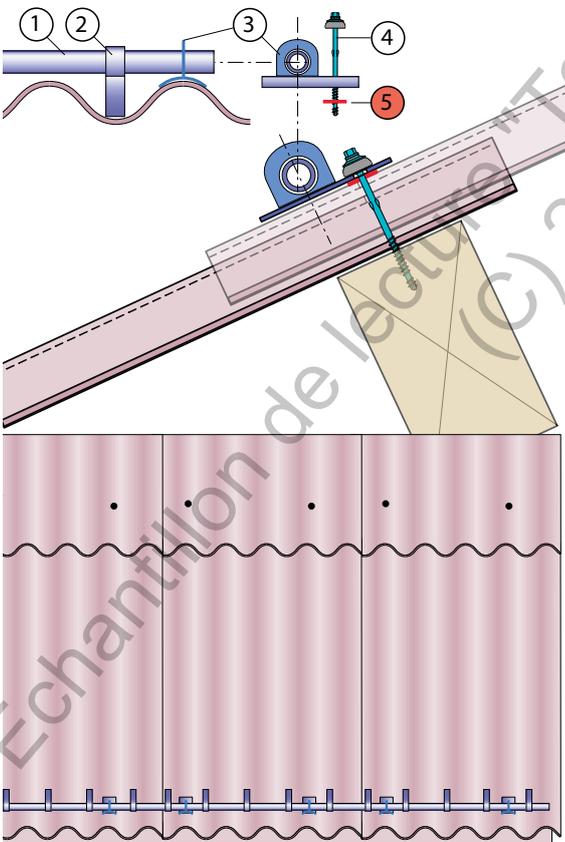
/313: Pare-neige à tubes sur plaques ondulées, (exemple: égout avec étriers de retenue de glace); tube (1), étrier de retenue de glace (2), support de tube (3), vis avec étoupage (4), disque d'étanchéité en caoutchouc (5)
